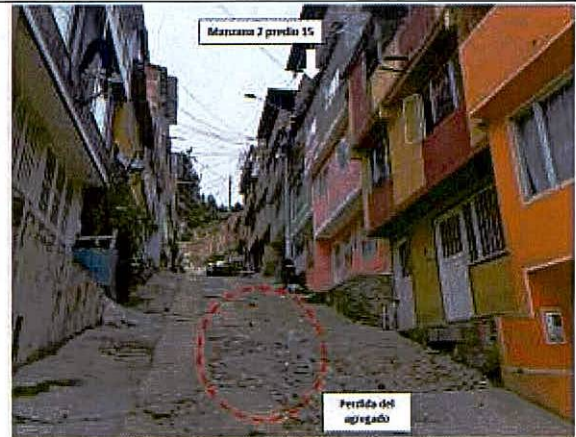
Vista de la vía Calle 164 b, presenta pendiente y deterioro en el adoquín
